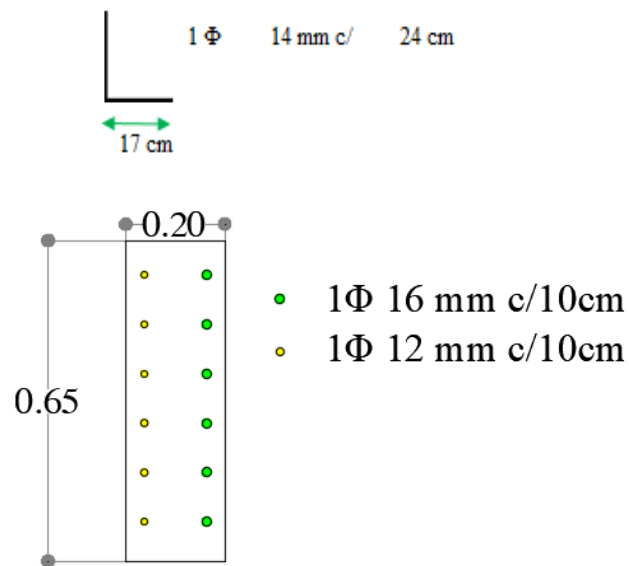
Armado del parapeto, análisis en sentido longitudinal (vista frontal)
